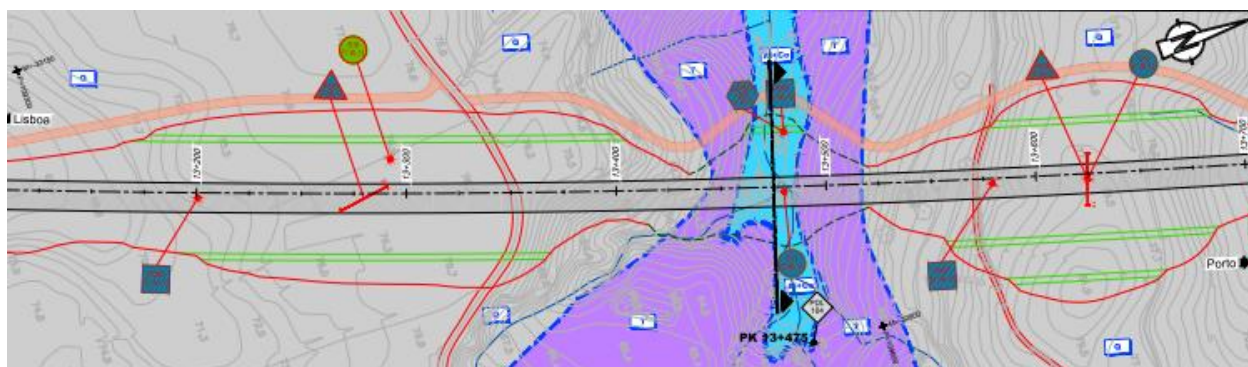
Extracto da planta geológica do Des. PF102A1.01.07.00.00.127
